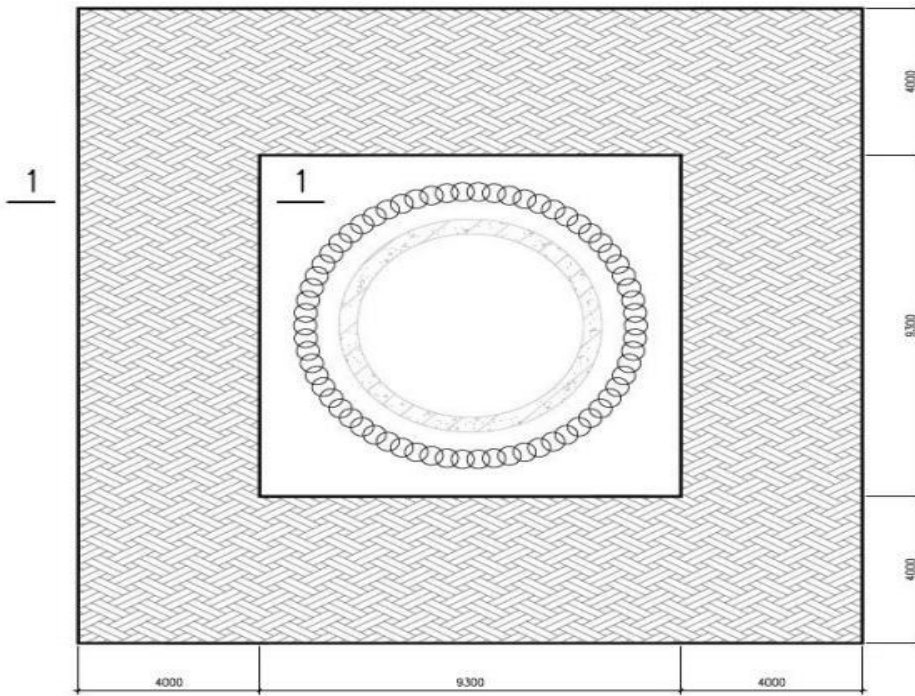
海边顶管接收井（节点 WS-212）围堰平面图
